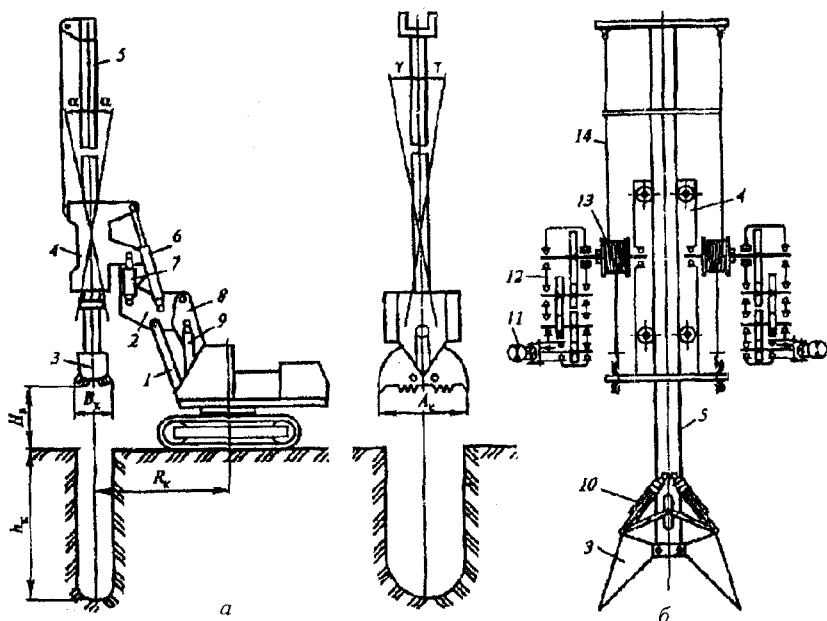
Грейферное оборудование для возведения сооружений методом «стена в грунте»: а — общий вид; б — кинематическая схема механизма
